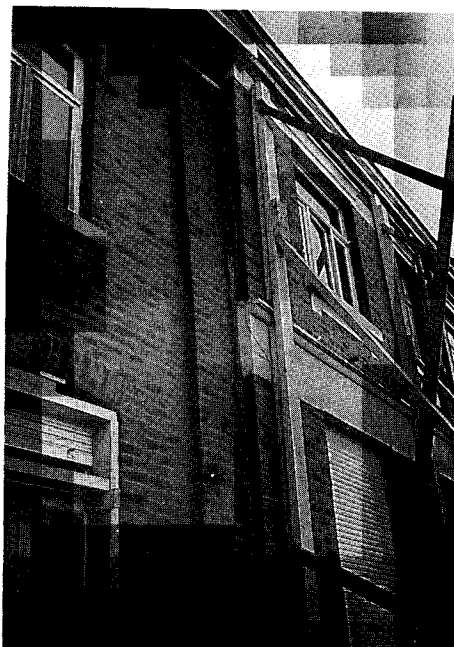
Mouvement de façade perpendiculairement à son plan.
